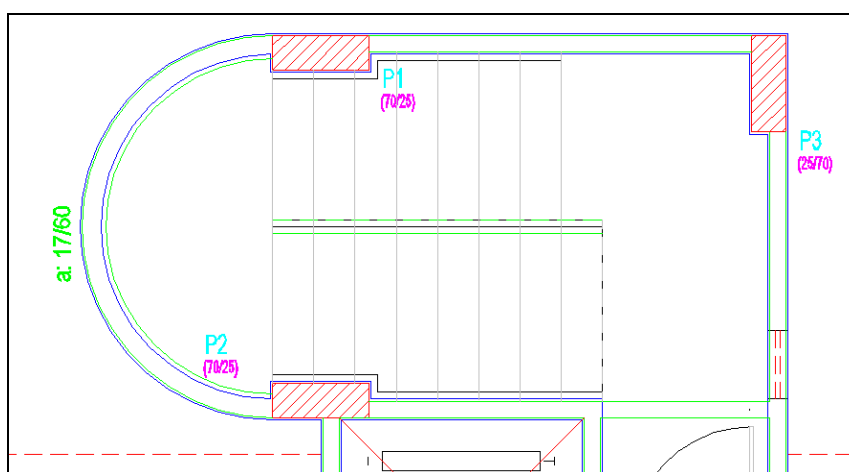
Pilar invadindo a escada e saliência da viga entre P1 e P2 (Pavimento Tipo)
